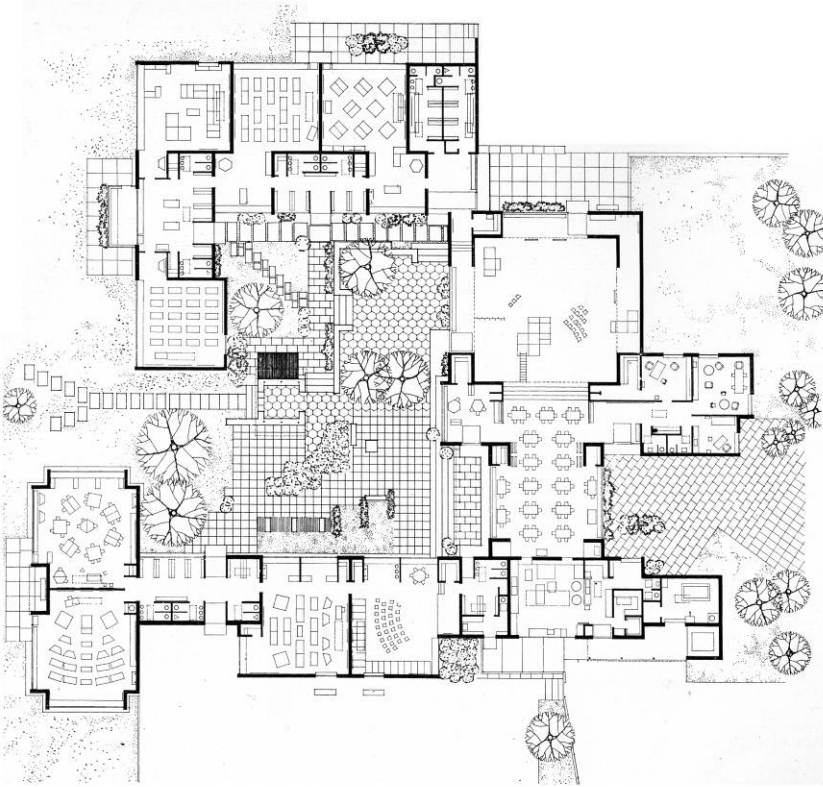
Development Group.Scuola elementare, Amersham, Inghilterra, 1957. Planimetria generale.
